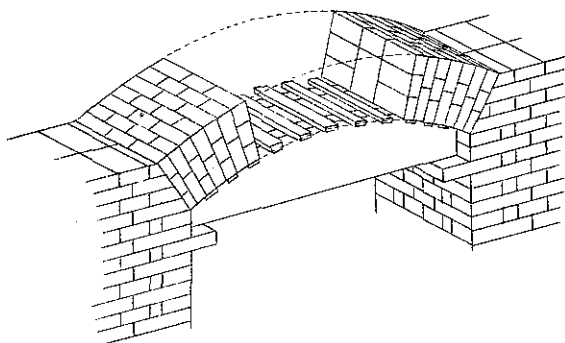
1½-stens murbue i 2-stens murværk (T. E. Hemmingsen: »Bygningskonstruktionslære« I).
